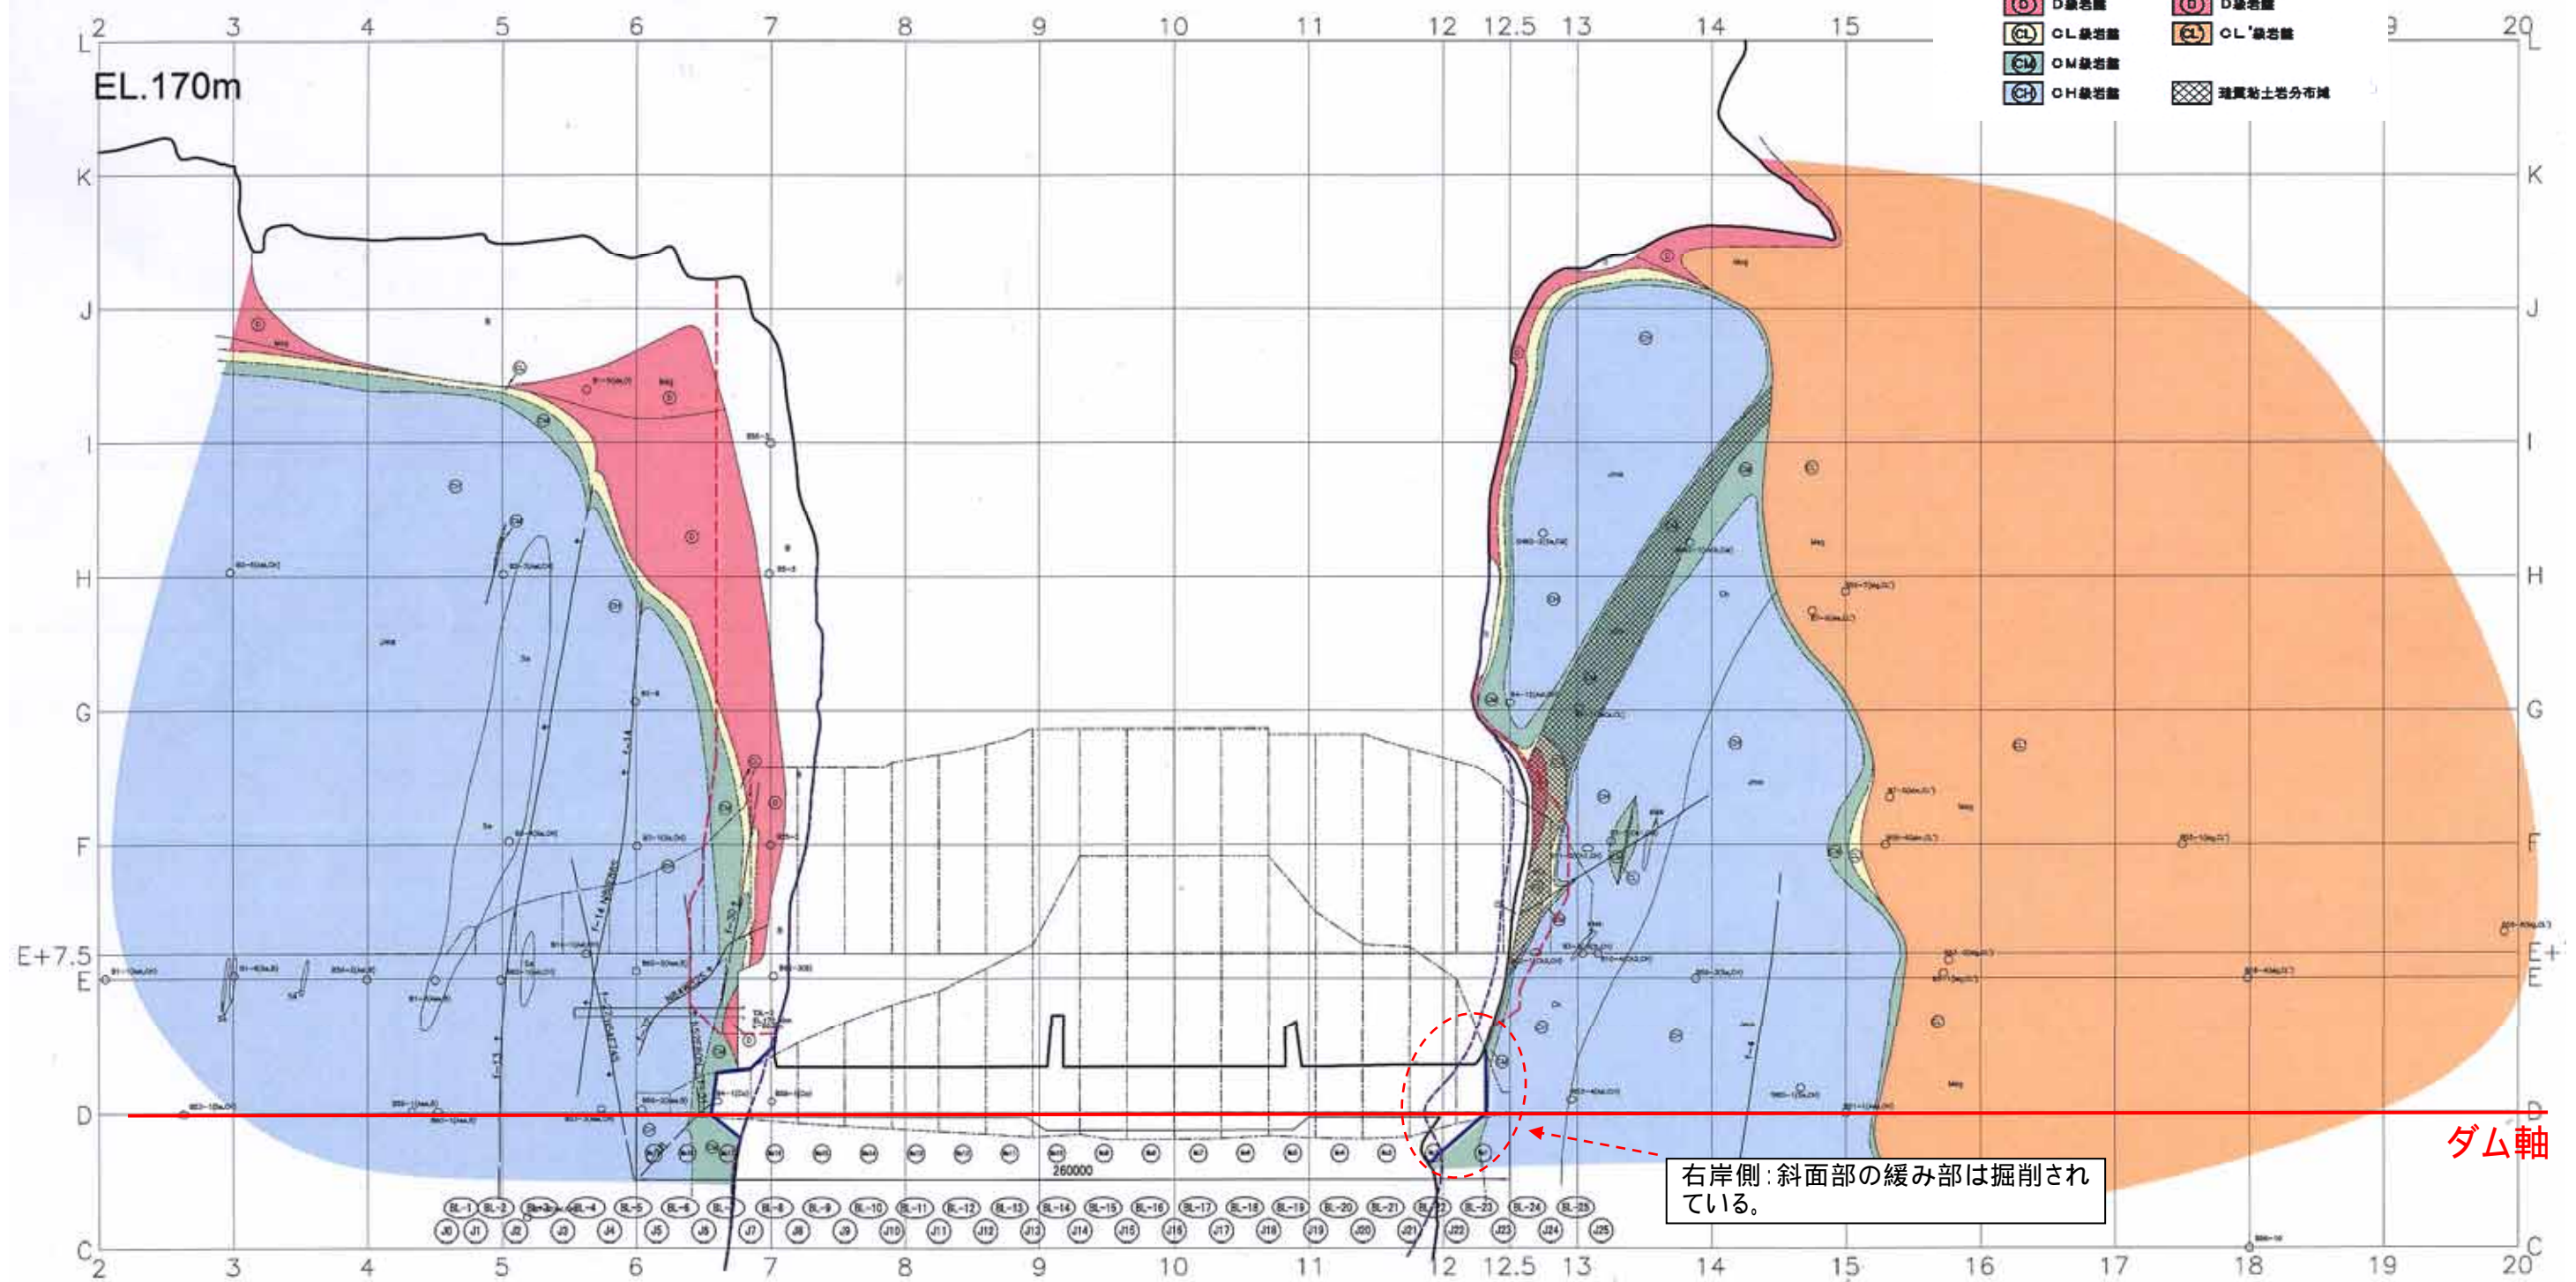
丸山ダムの基礎岩盤の状況 (EL.170m 岩級区分水平断面図)
